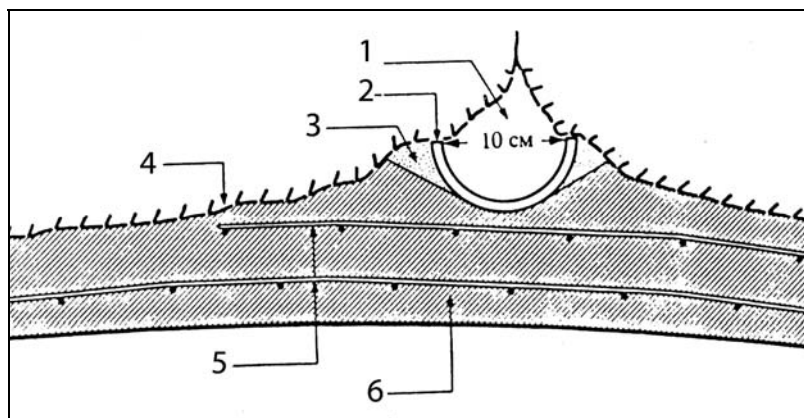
Пример устройства водоотвода (дрены) за пределы покрытия из торкрет-бетона. 1 – дрена; 2 – желоб; 3 – быстротвердевающий раствор; 4 – скальная порода; 5 – арматурная сетка; 6 – торкрет-бетон.
